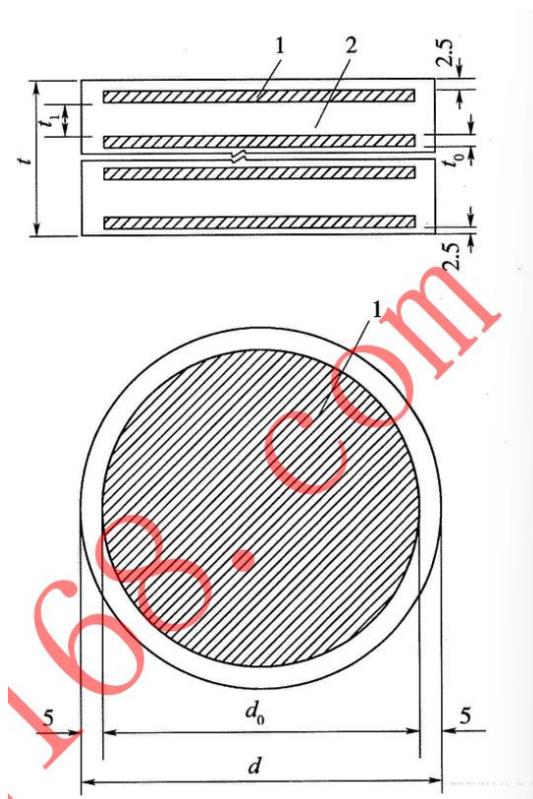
圆形板式橡胶支座结构示意图（单位：mm）
